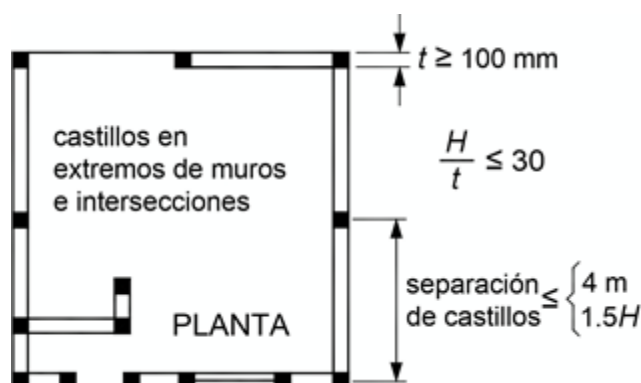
Requisitos de la construcción con mampostería confinada en planta.
